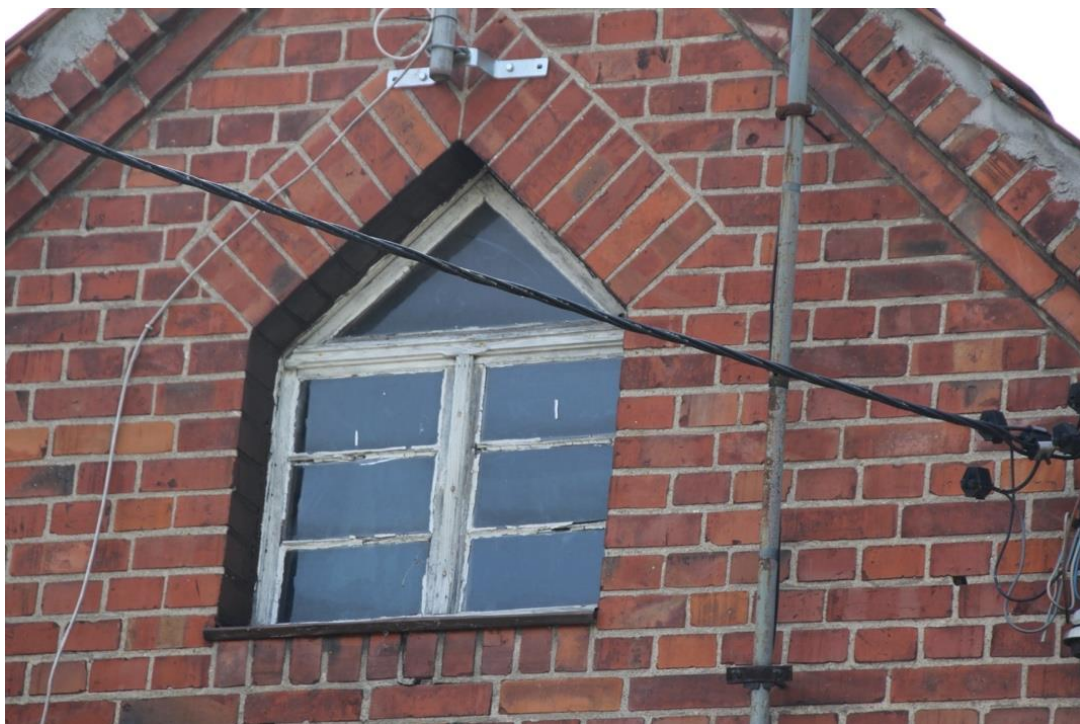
Elewacja frontowa, wschodnia. Widok ogólny.
